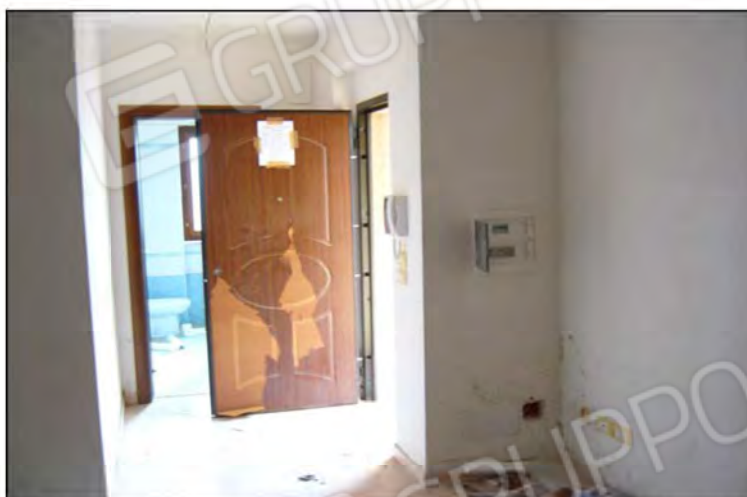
vista su corte appartamento 3° piano di Via B. Croce – Part. n°1033, Sub. 13)
